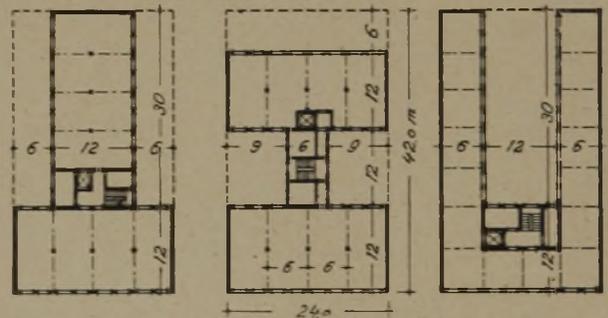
Grundrisse für städtische Grundstücke und geschlossener Bebauung.
